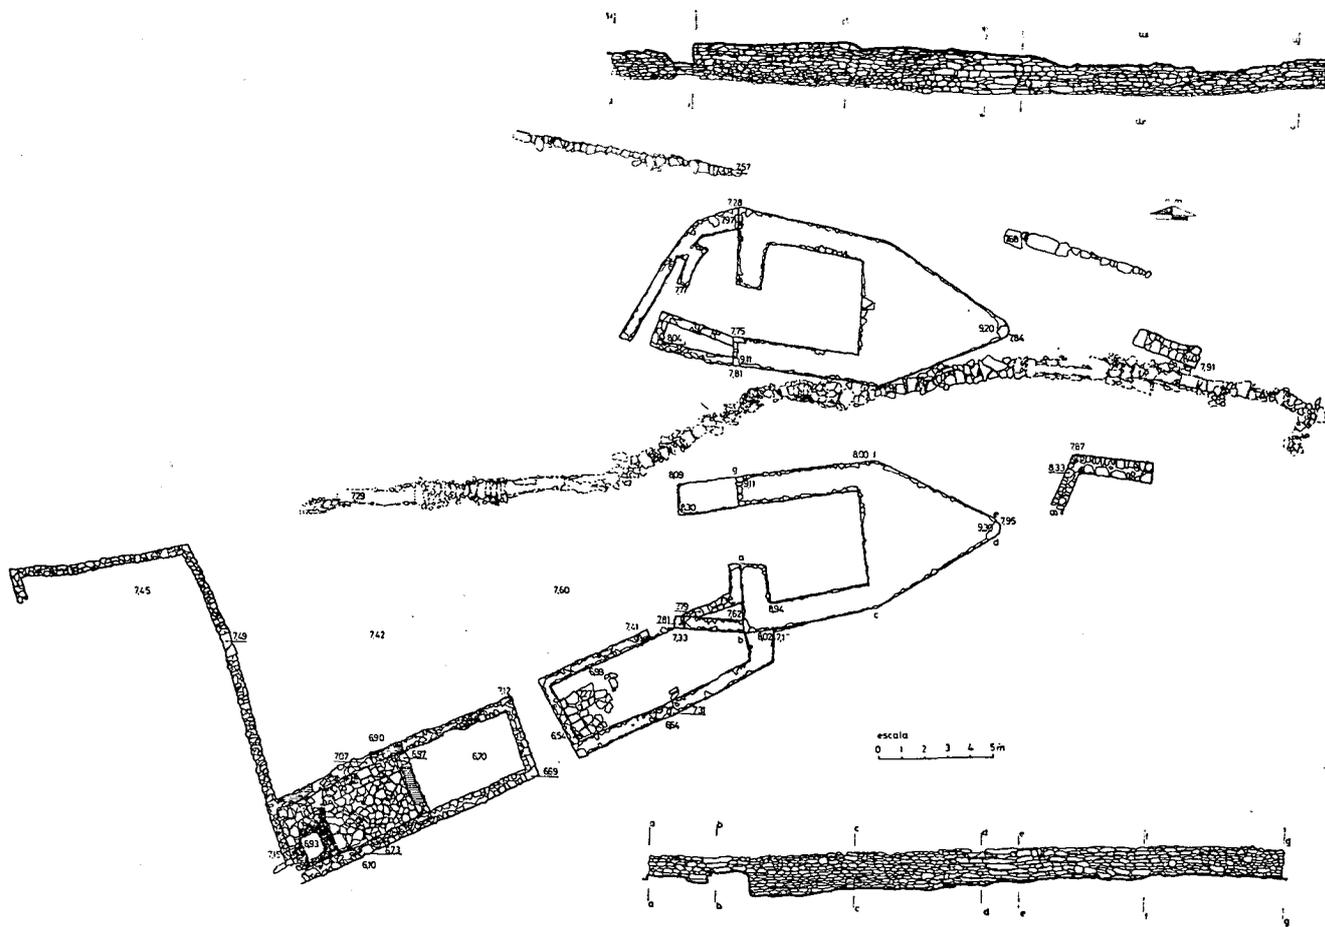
Planta y alzado de las dos torres pentagonales y tramo de muralla.
